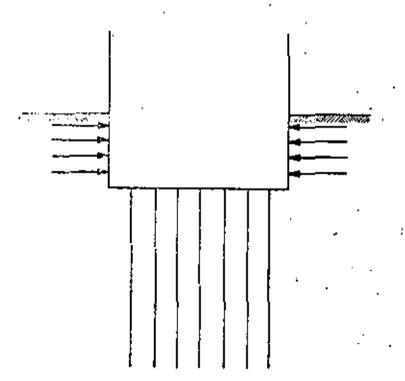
Encajonamiento de la cimentación para absorver las fuerzas horizontales producidas por la superestructura
